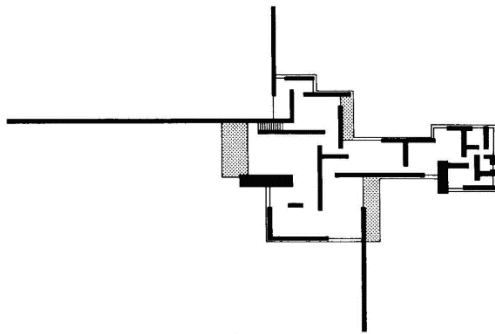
Mies Van der Rohe, Planta de su casa de campo en ladrillo, 1924
